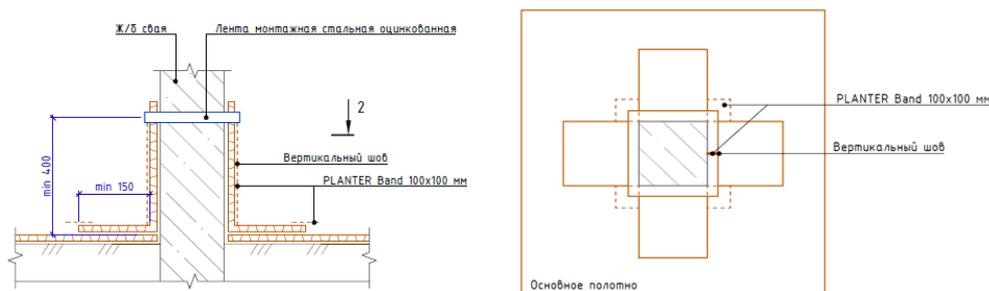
Угол примыкания PLANTER Geo к прямоугольной свае
